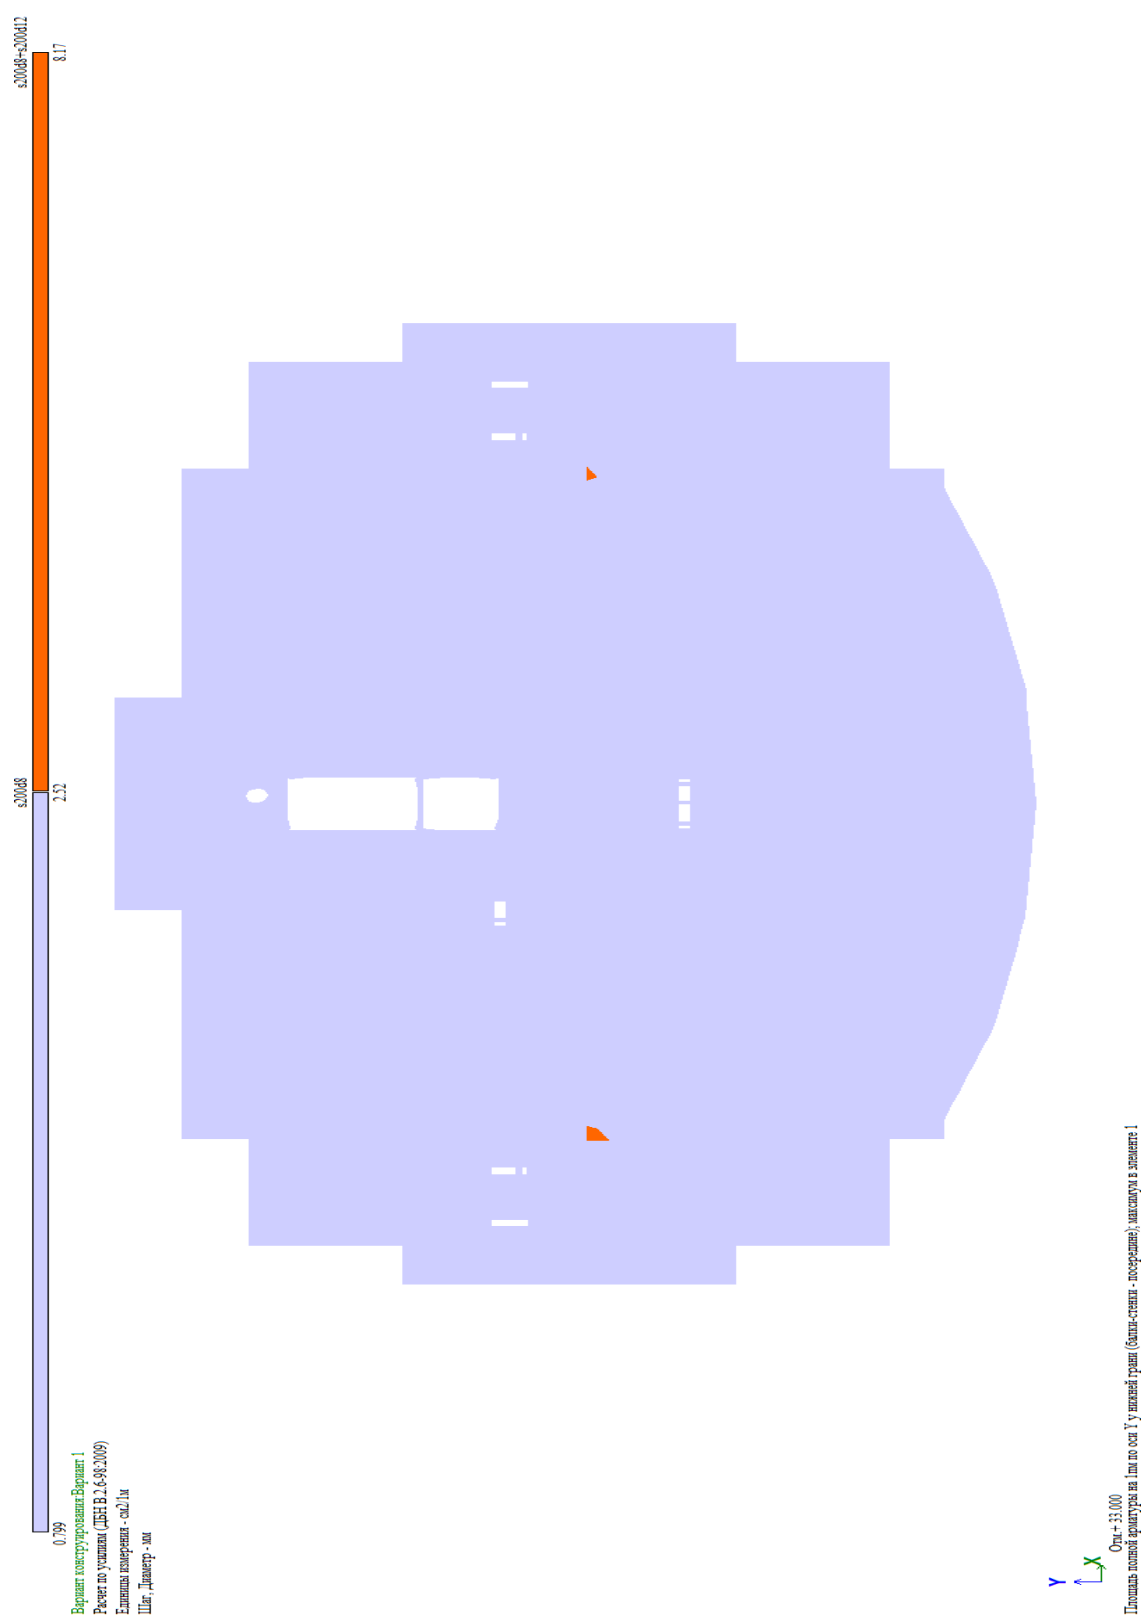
Розташування поздовжньої арматури по осі Y у нижній зоні
